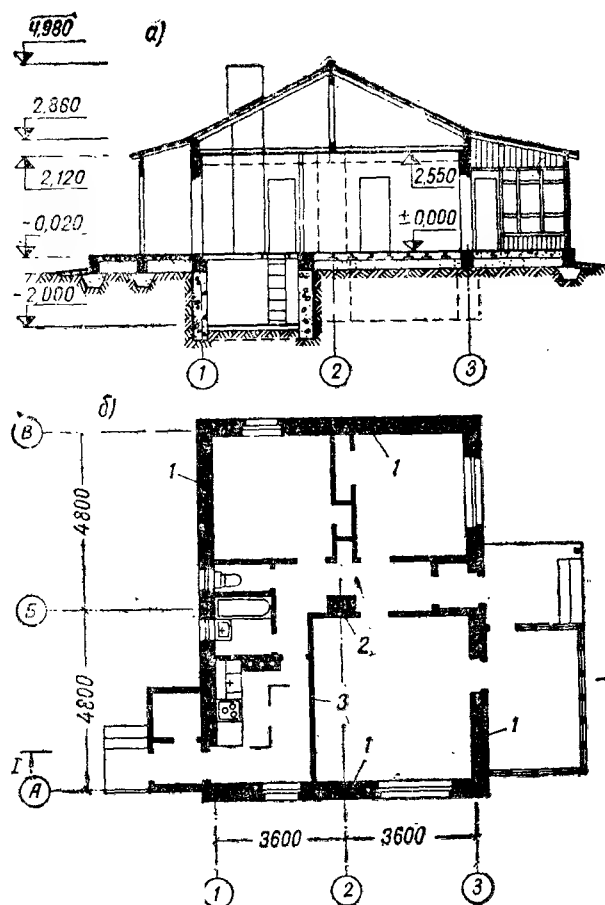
Малоэтажное каменное здание с неполным каркасом
